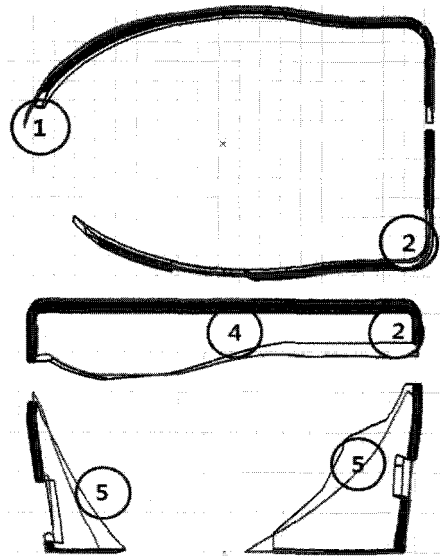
As-Planned와 As-Built 중첩단면비교(Plan & Section, ■: Built, ■: Planned).
